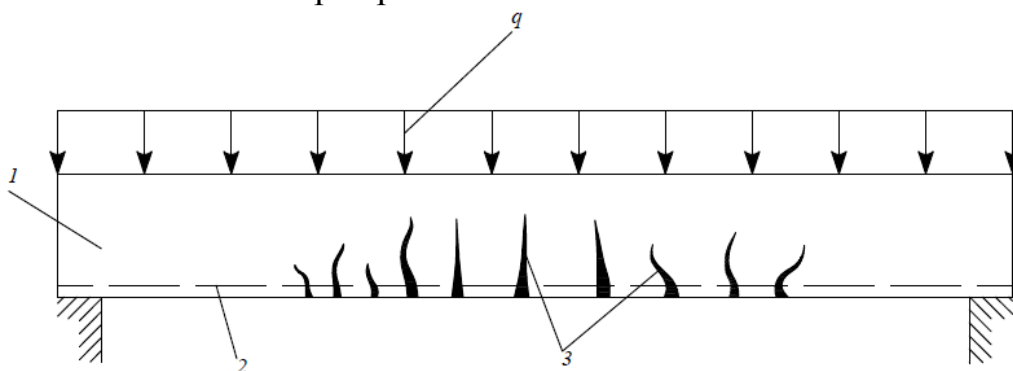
Трещины в нормальном сечении железобетонных изгибаемых
